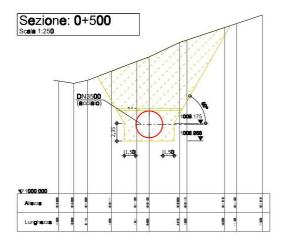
Le sezioni di posa della condotta forzata a monte ed a valle dell'attraversamento.
